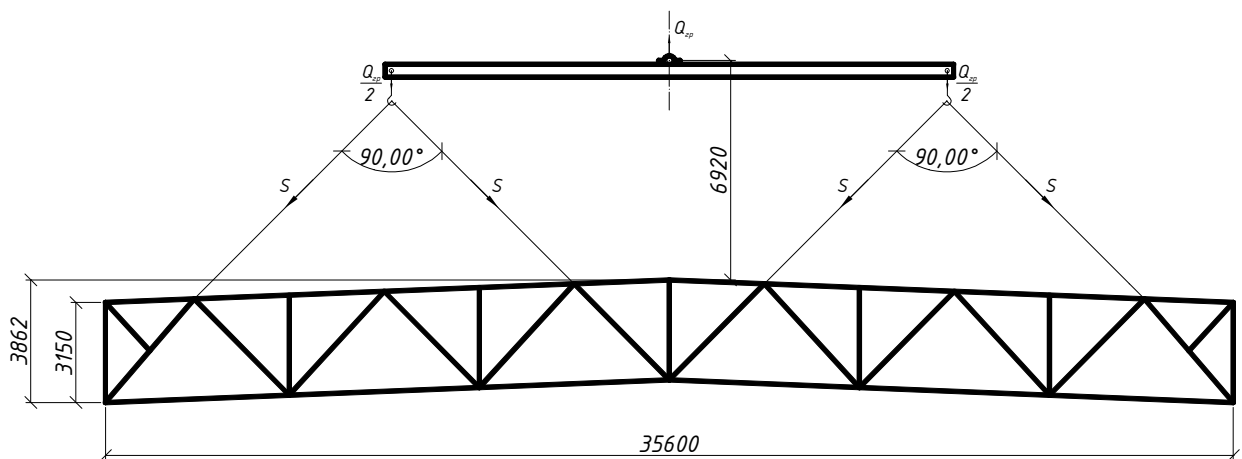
Розрахункова схема строповки гнучкими канатами
